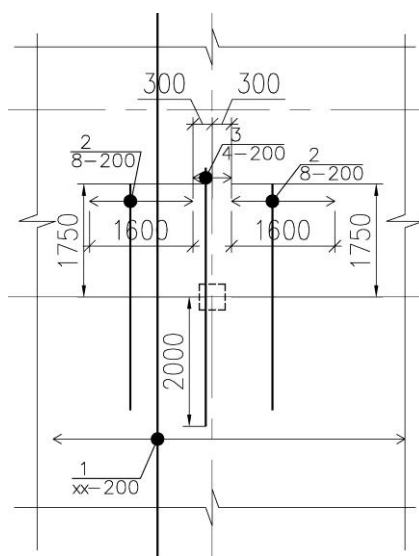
Пример конструктивного решения армирования верхней зоны перекрытия в направлении цифровых осей (вдоль местной оси Y1). Условные обозначения: в числителе – номер позиции арматурного стержня; в знаменателе – шаг стержней (в мм).
